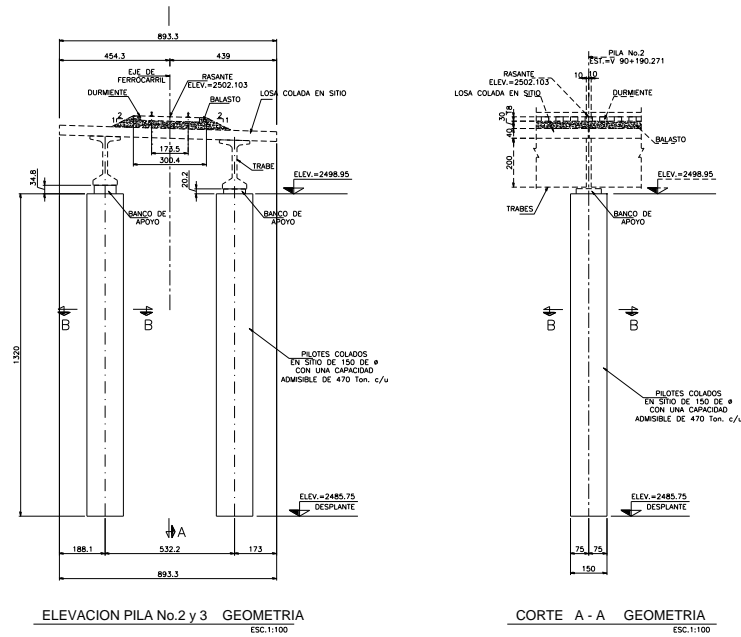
Geometría típica de la pila intermedia no. 1 y no. 2.
